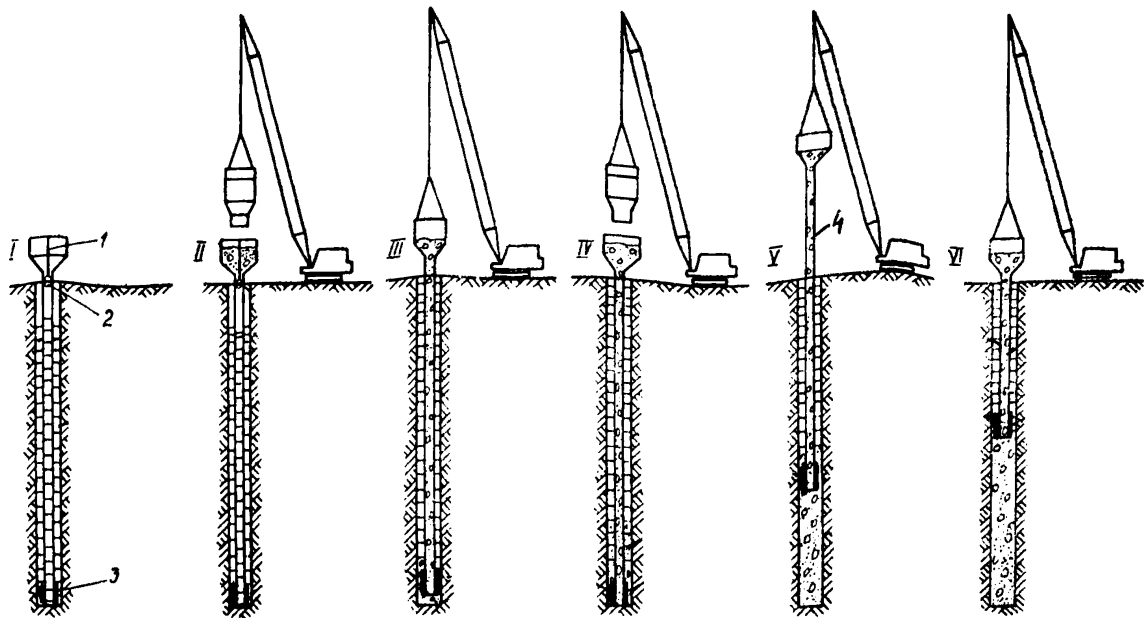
Последовательность операций при бетонировании свай-оболочек бетонной смесью с вибрированием: I-установка на забой бетонной тубы с подвешенной скользящей пробкой; II-заполнение приемной воронки бетонной смесью; III-спуск первой порции бетона - туба приподнята над забоем; IV-заполнение приемной воронки второй и последующими порциями бетона; V-процесс бетонирования - туба приподнята на высоту подъема гака стрелы крана; VI-бетонирование после изъятия обжимной тубы; 1-подвес пробки; 2-стальная скользящая пробка; 3-вибратор
